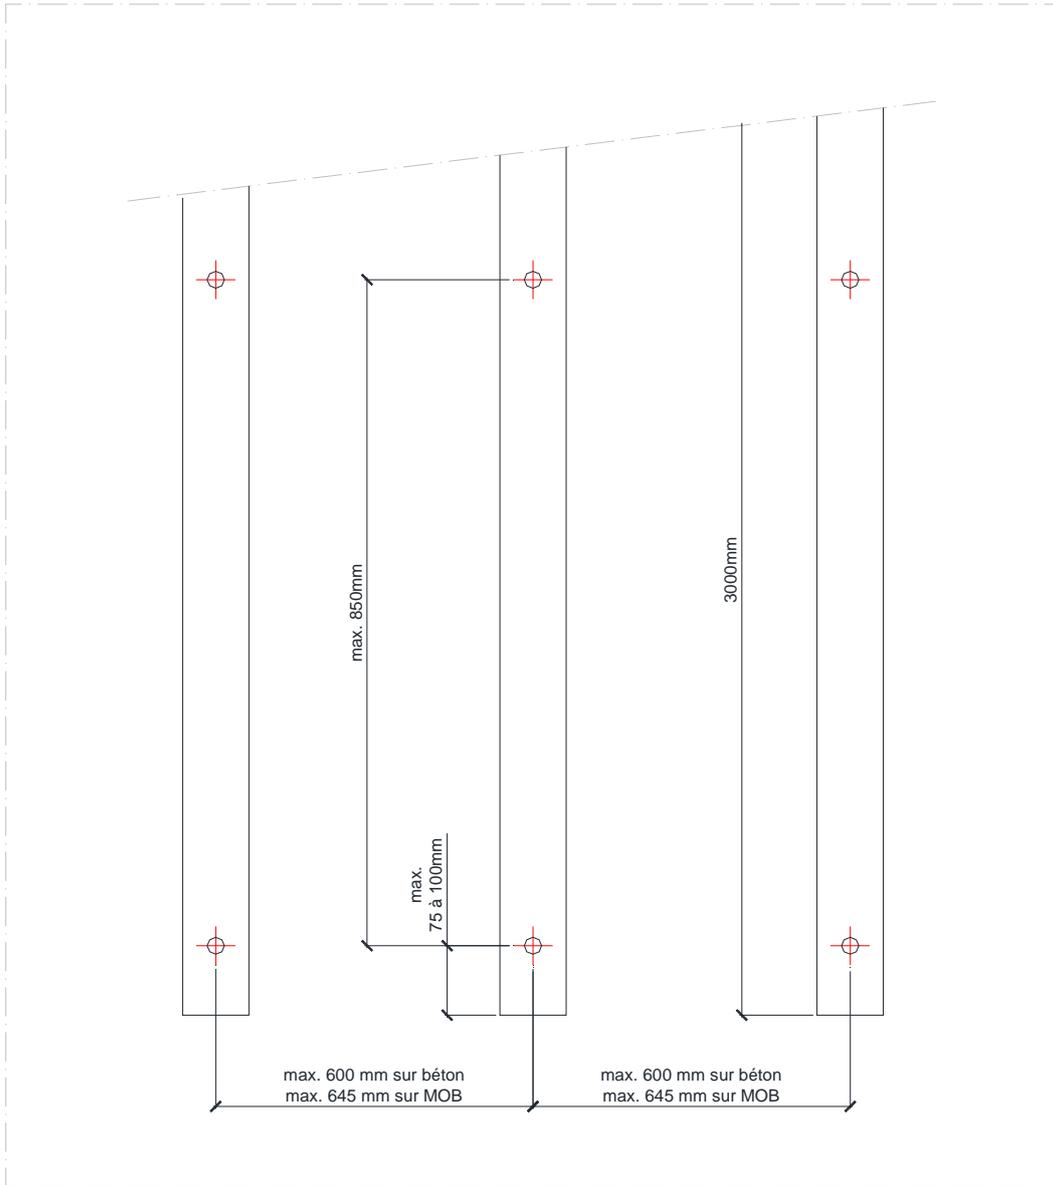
Fixation directe sur le support – Ossature bois – Détail implantation des chevilles
